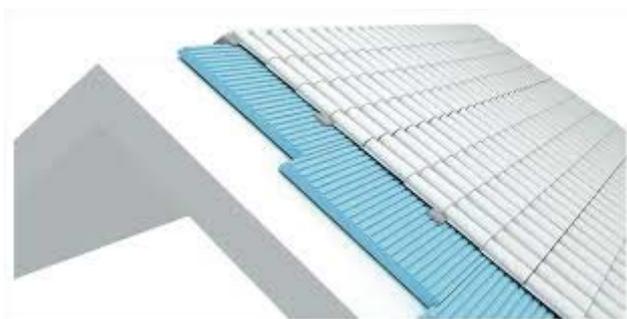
Cubierta inclinada con XPS bajo teja (Fuente: [www.soprema.es](http://www.soprema.es))
